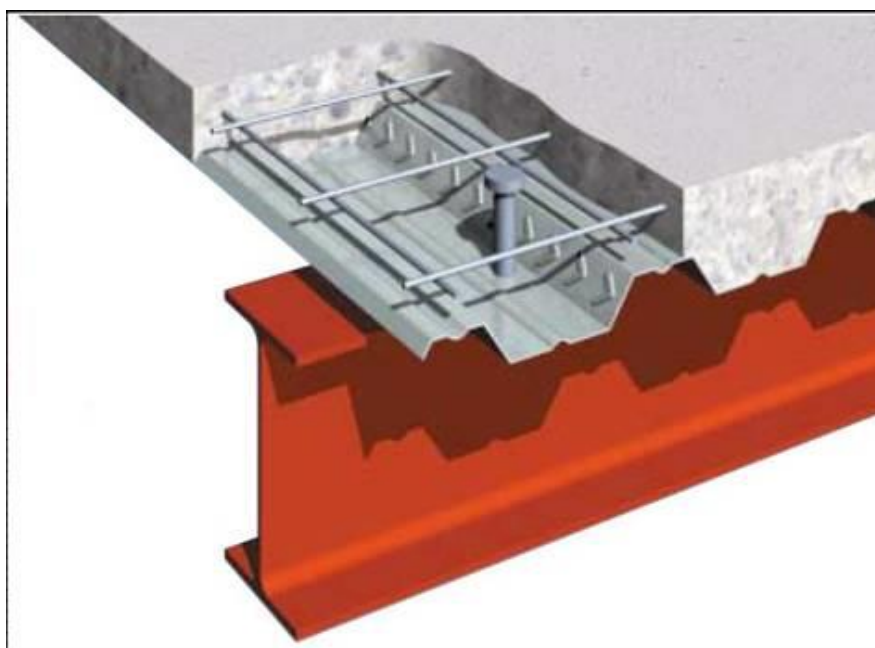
Esquema das lajes Steel Deck (GEMNEXUS,2014)
